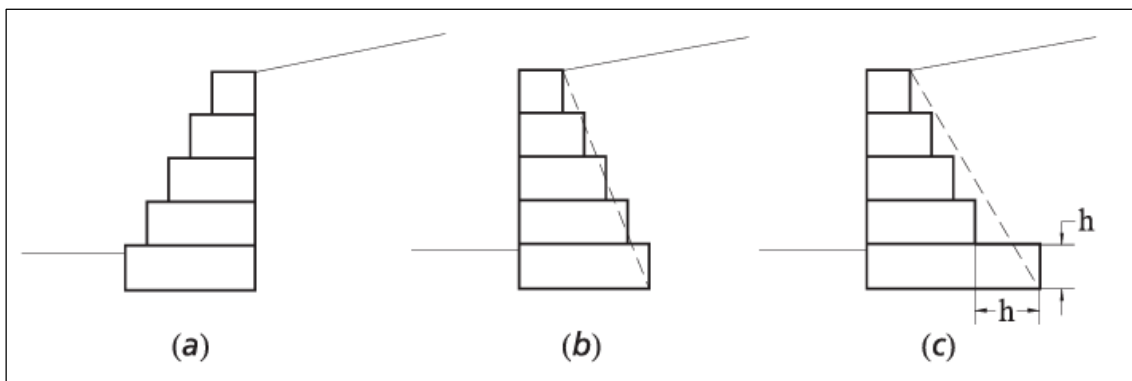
Plano de aplicação do empuxo ativo (Barros, 2021)
